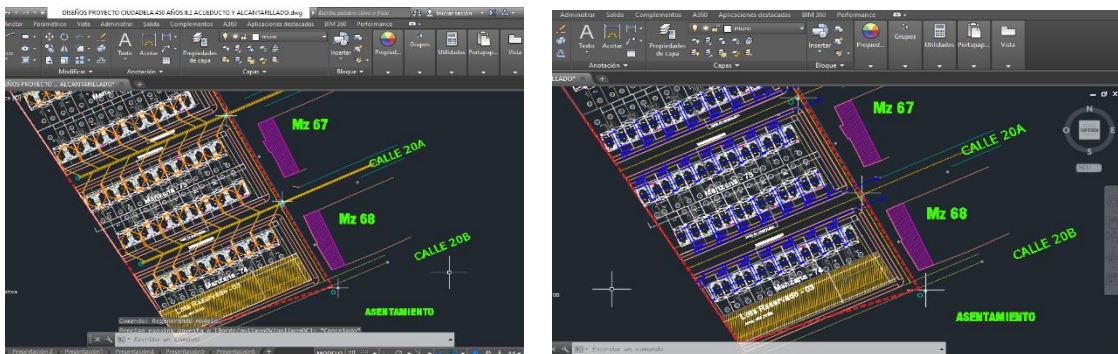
Plano alcantarillado vivienda unifamiliar primer piso.
